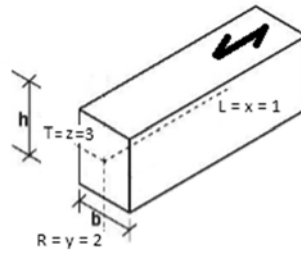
Ejes y dirección de la fibra en la pieza.
